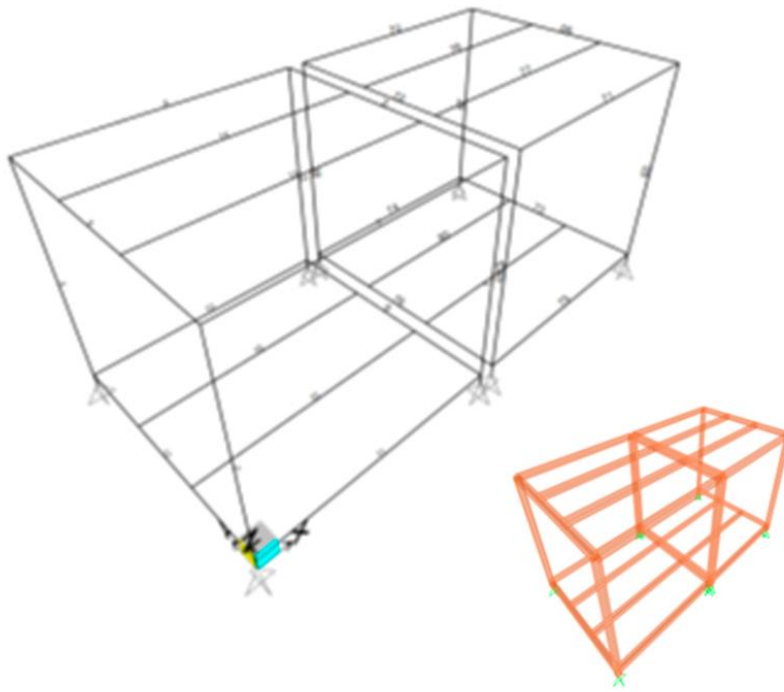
Planta y alzado y el módulo de 3D. Fuente : Elaboración propio.
